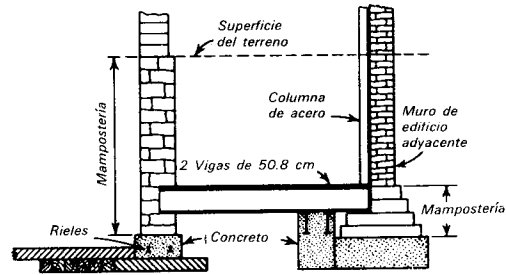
Zapatas en cantiliver para soportar una columna exterior del Auditorium Building, Chicago, 1887.
